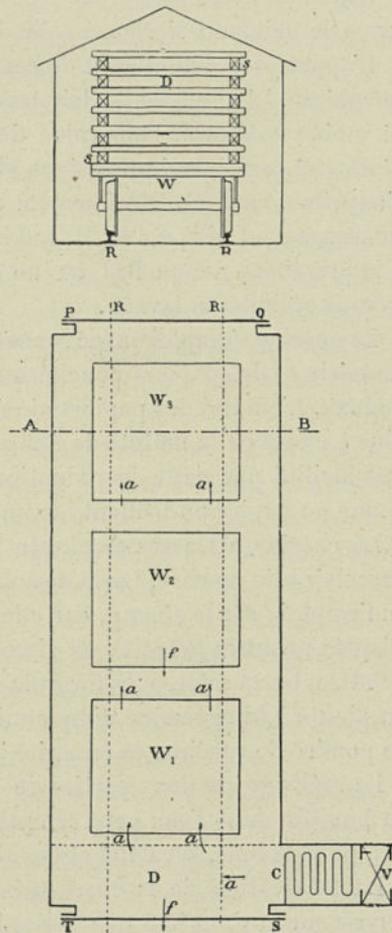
et 13. — Coupe transversale et plan du tunnel-séchoir pour caséine.
